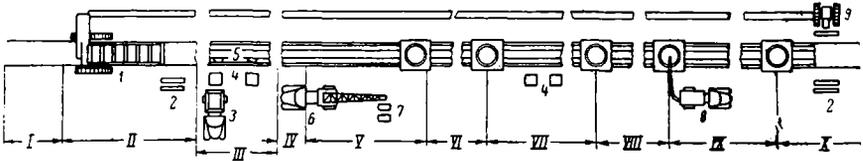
Технологическая схема устройства коллектора из бетонных (железобетонных) труб на монолитном основании:
